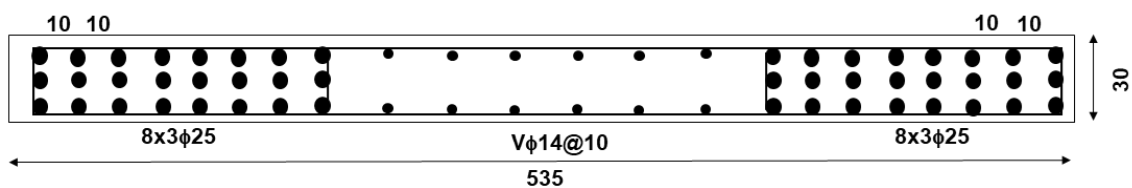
Distribución del Refuerzo Longitudinal Muros MI
